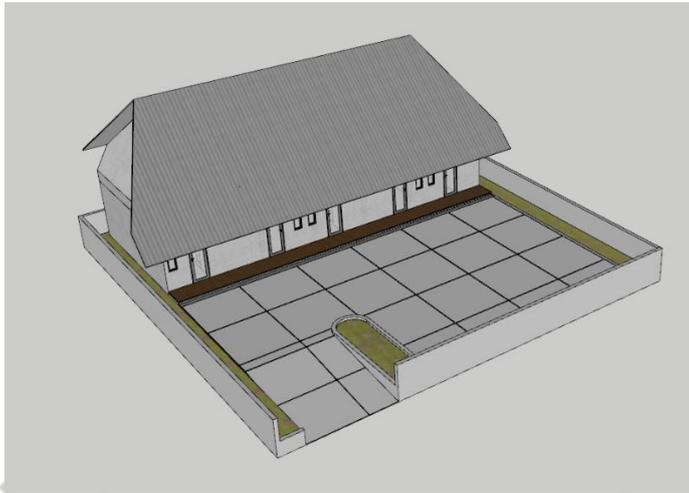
Alternatif site 3 lantai 1 (Sumber: Data pribadi praktikan 2024)
